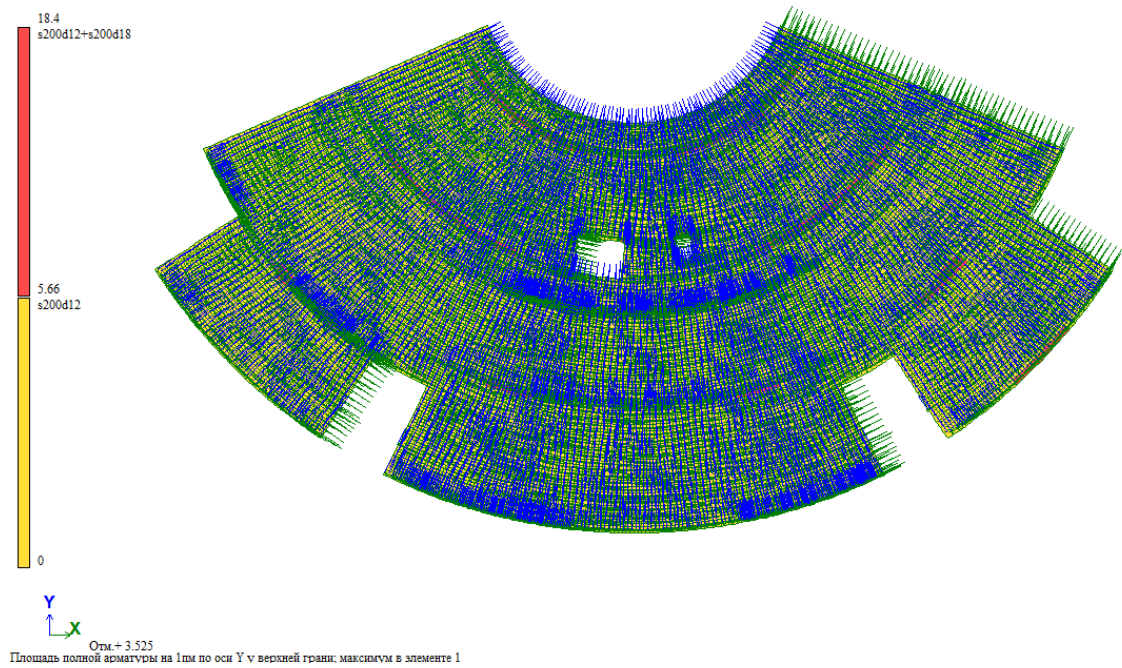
Площадь арматуры на 1м по Y у верхней грани
